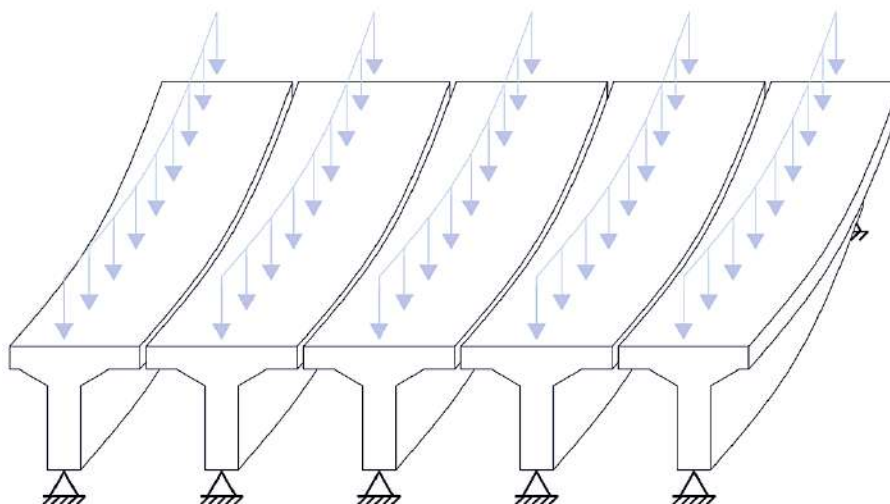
Longarinas carregadas constituindo o tabuleiro da ponte. Fonte: adaptada de Cavalcante (2019)
